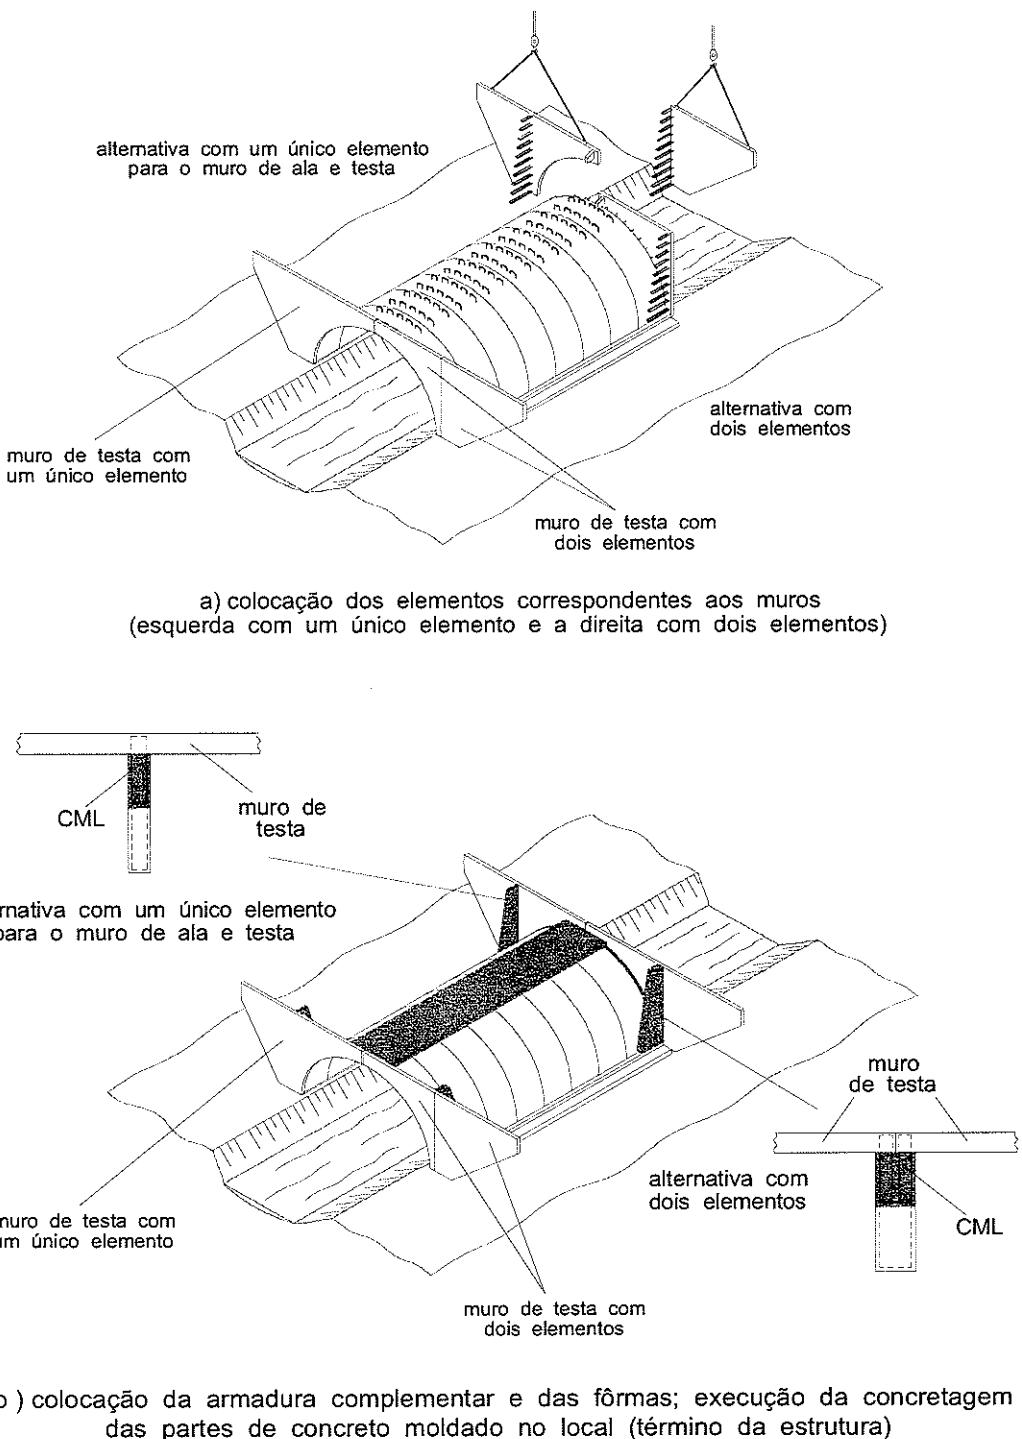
Alternativa com os muros alinhados – etapas da construção
